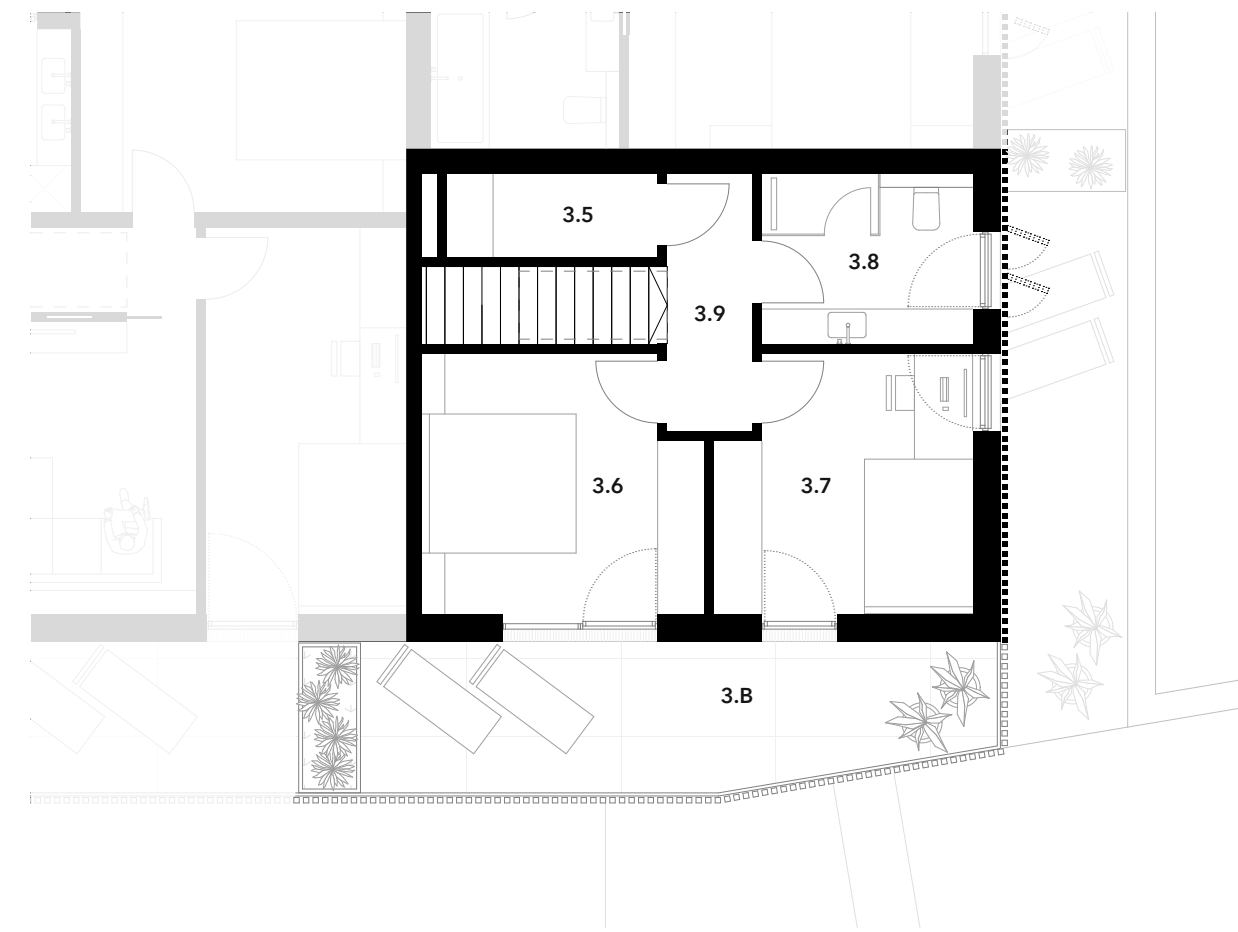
Grundriss Obergeschoß TOP 3
